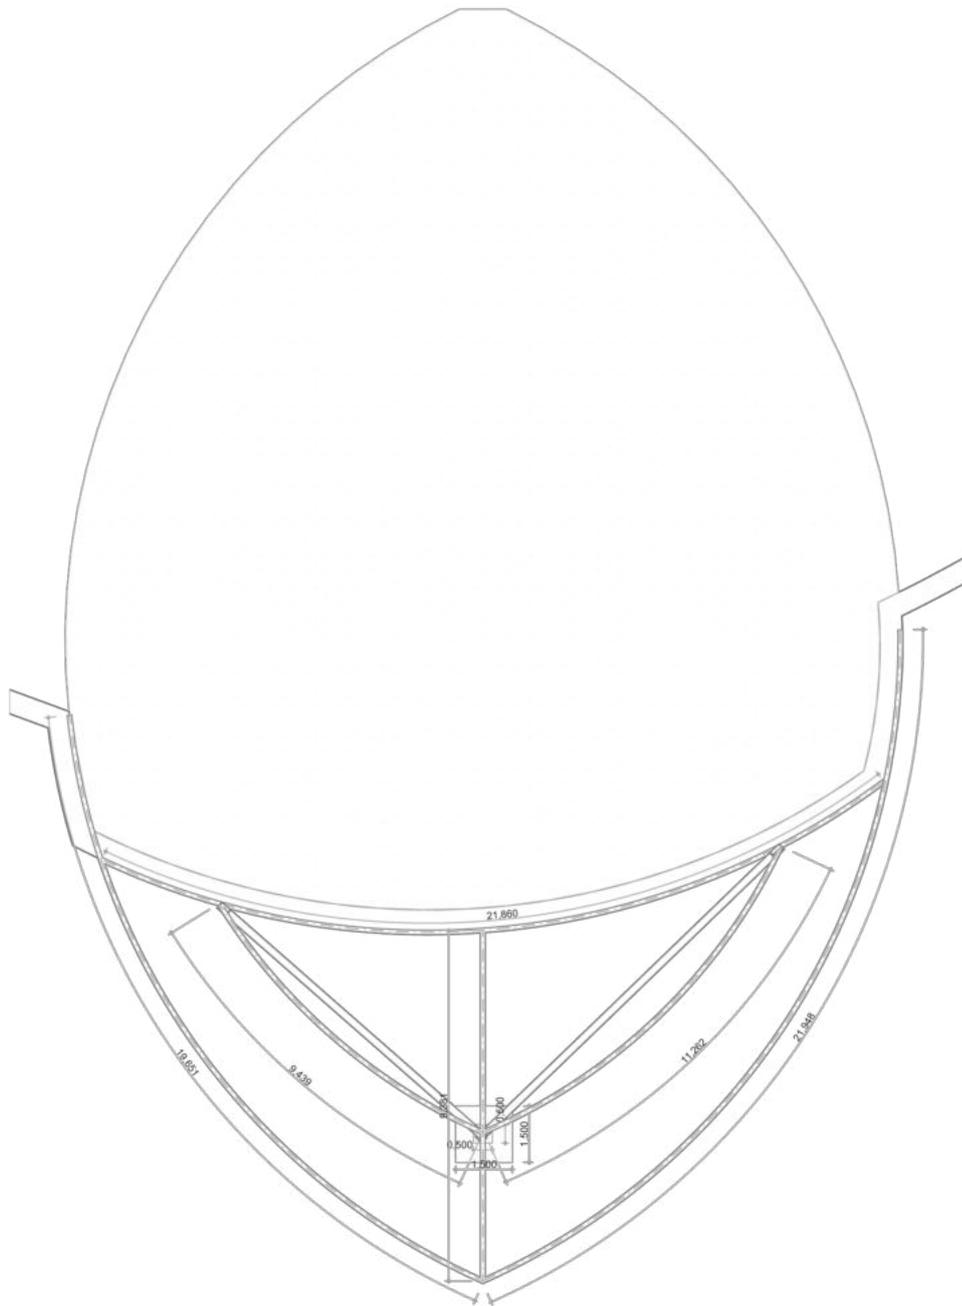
Planos 3– Detalle de Axonometría de Mirador. Fuente: Elaboración propia Nota: Detalle constructivo de mirador turístico
